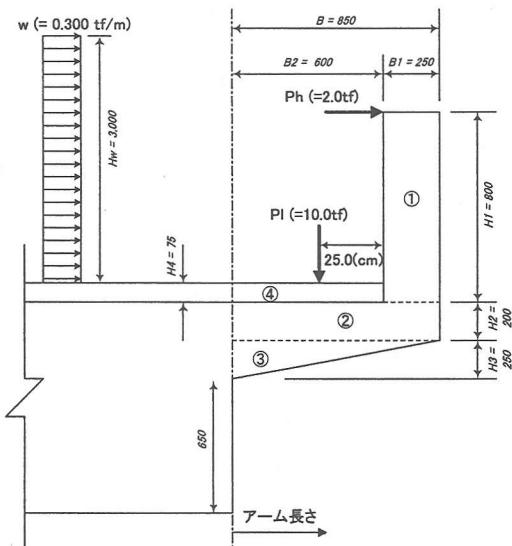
片持ち版部分の詳細寸法 (単位 : mm)
